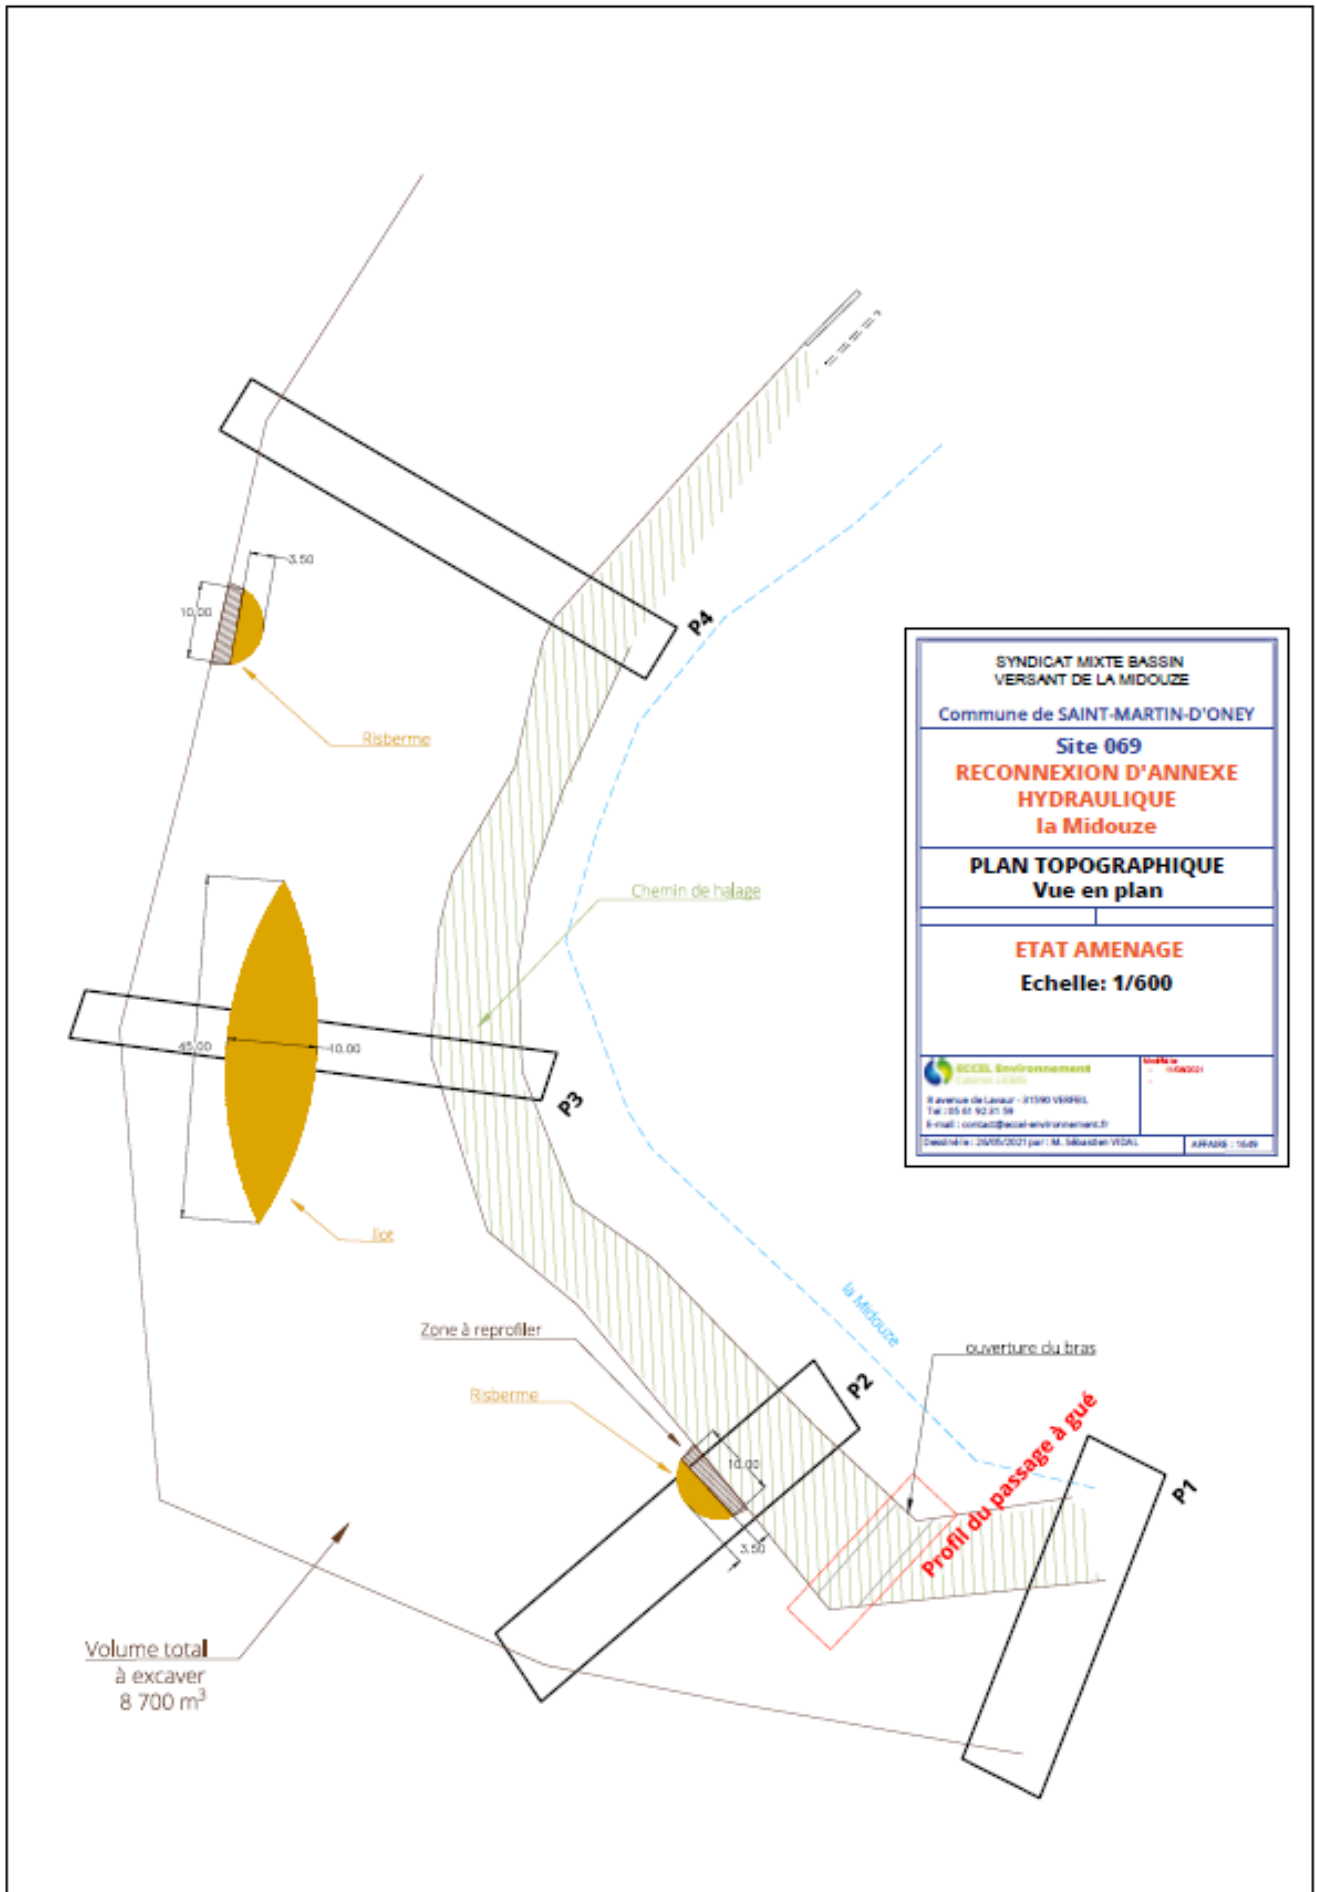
Vue en plan – Etat aménagé - Site Mi\_069
